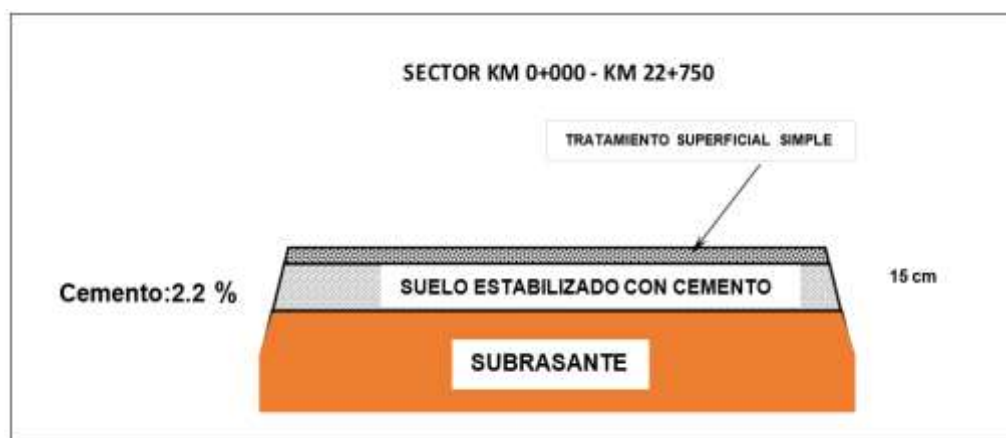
Estructura del pavimento. Fuente: Informe de diseño del pavimento.
